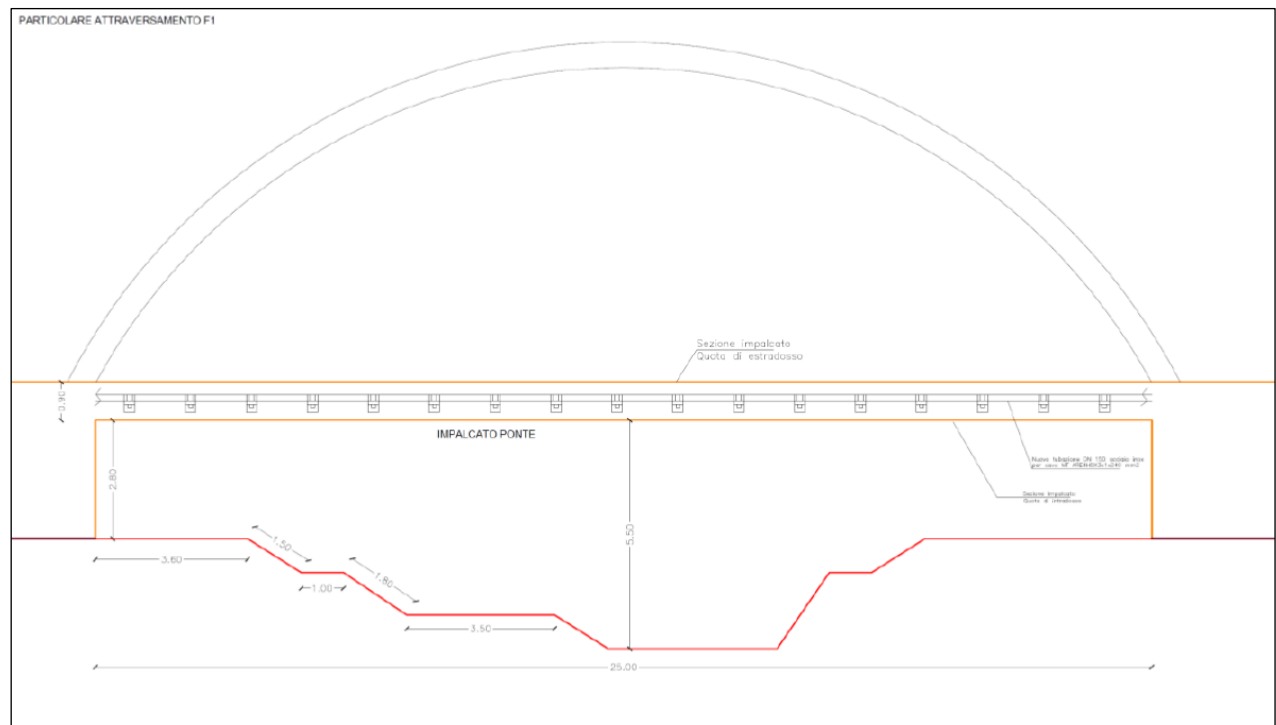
Particolare di ancoraggio tubazioni all’impalcato del ponte
